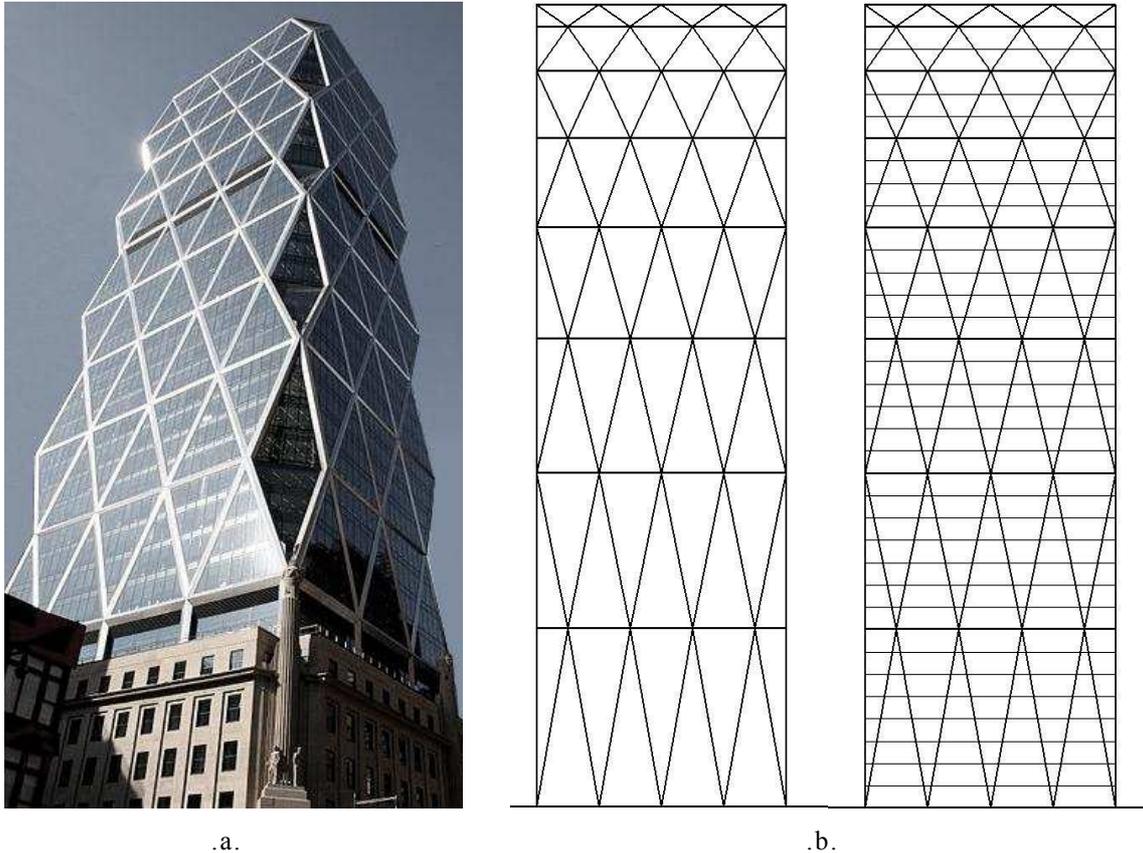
a) La *Hearst Tower* en Nueva York de malla estructural de doble diagonal, con plantas intermedias, b) Propuesta de distribución de plantas para la geometría adaptada según las líneas isostáticas. (Imágenes propias, 2008 y 2013 respectivamente).
